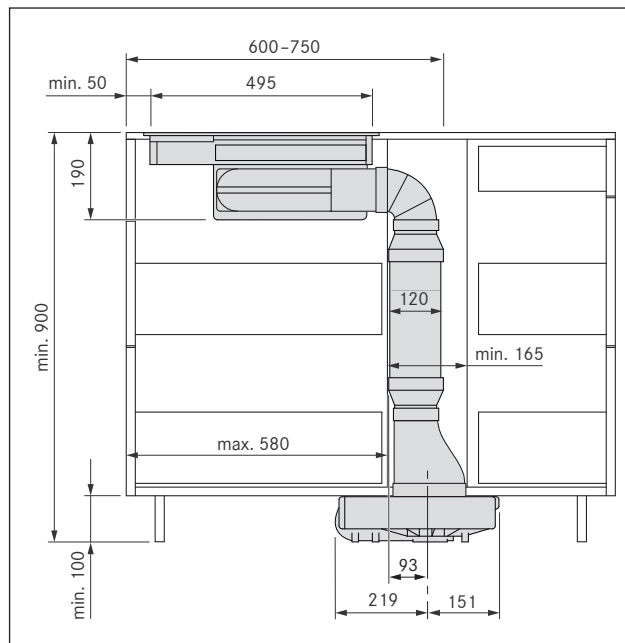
Dimensões de montagem do aparelho com silenciador plano USDF quando montado numa ilha de cozinha
